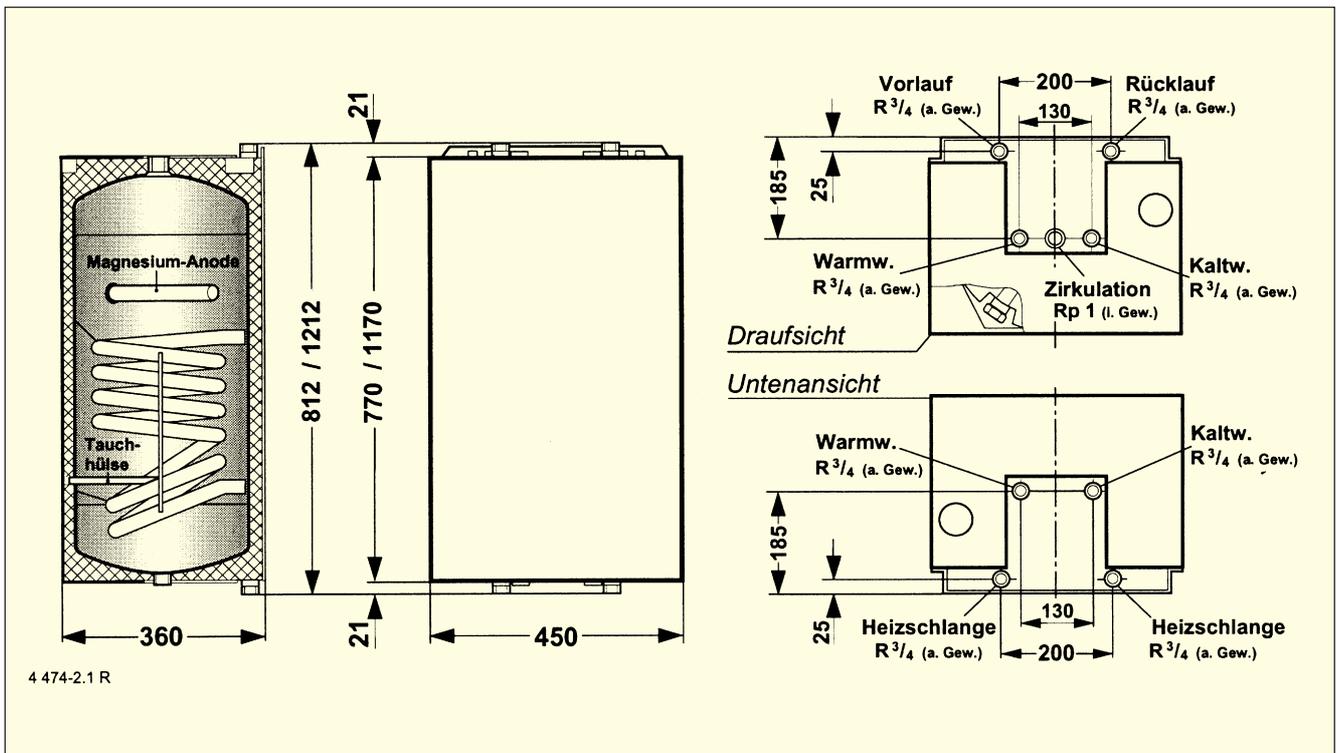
Maßangaben hinter einem Schrägstrich beziehen sich auf die nächstgrößere Speicherausführung.
